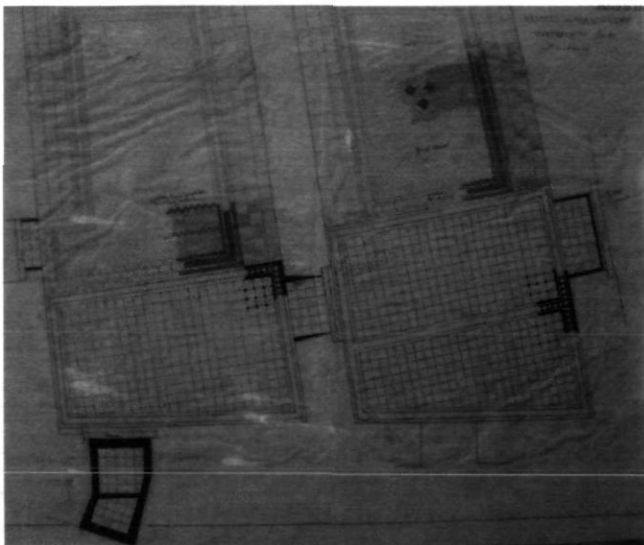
Plattegrond en details van de galerij ten behoeve van de ijzerconstructies uit maart-mei 1898. NAI/De Haar 1328.
